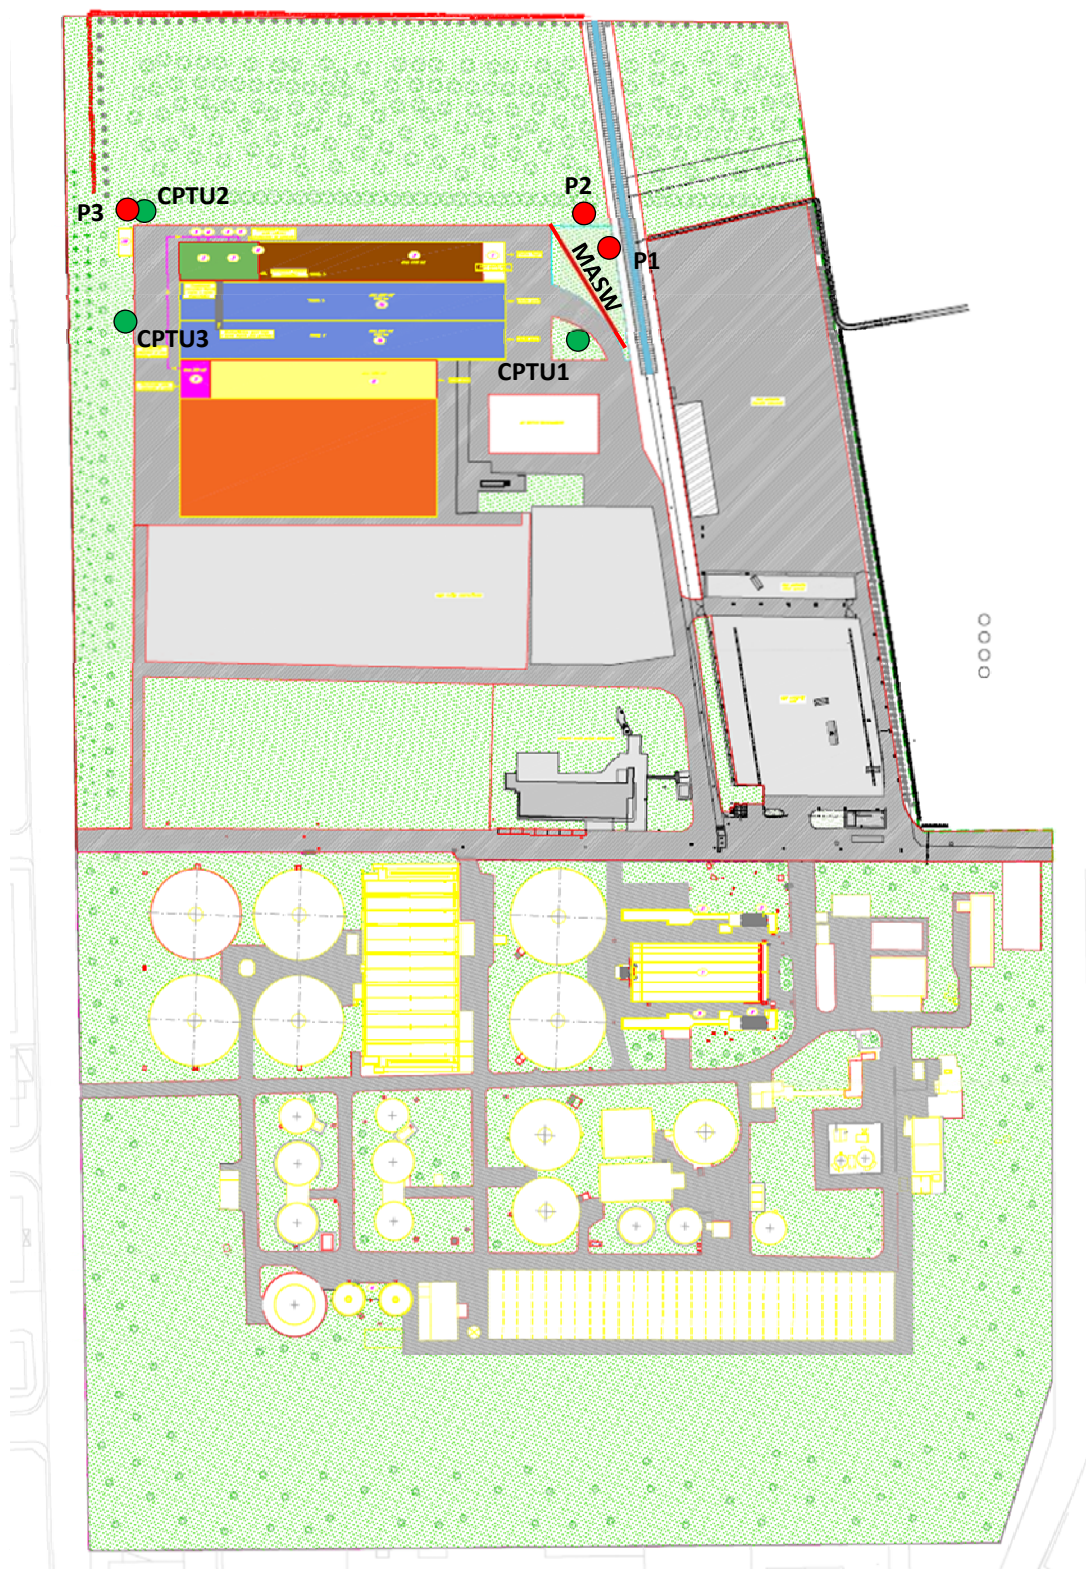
Ubicazione delle indagini su planimetria di progetto dell'opera
